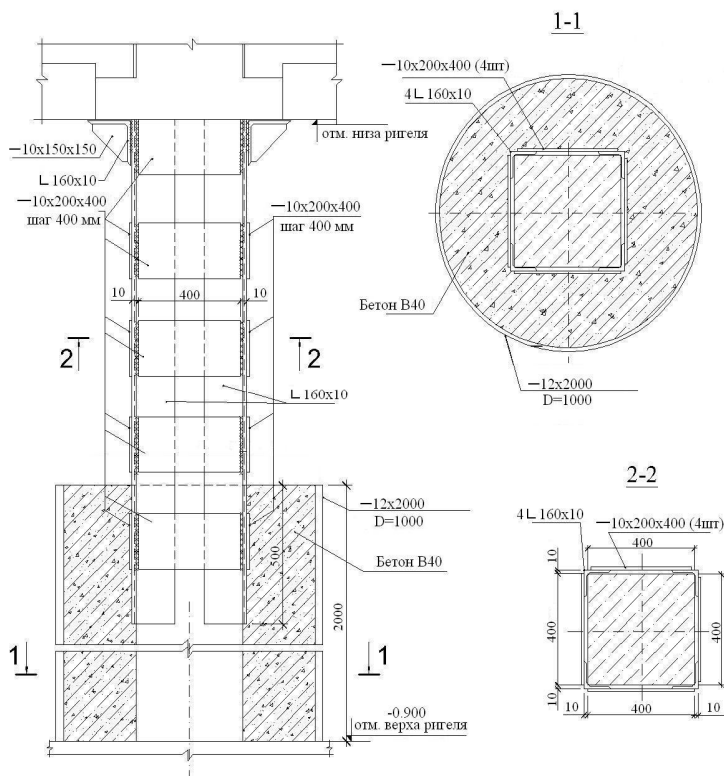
Усиление железобетонной колонны при разрушении стыка и потере устойчивости рабочей арматуры в зоне стыка.
